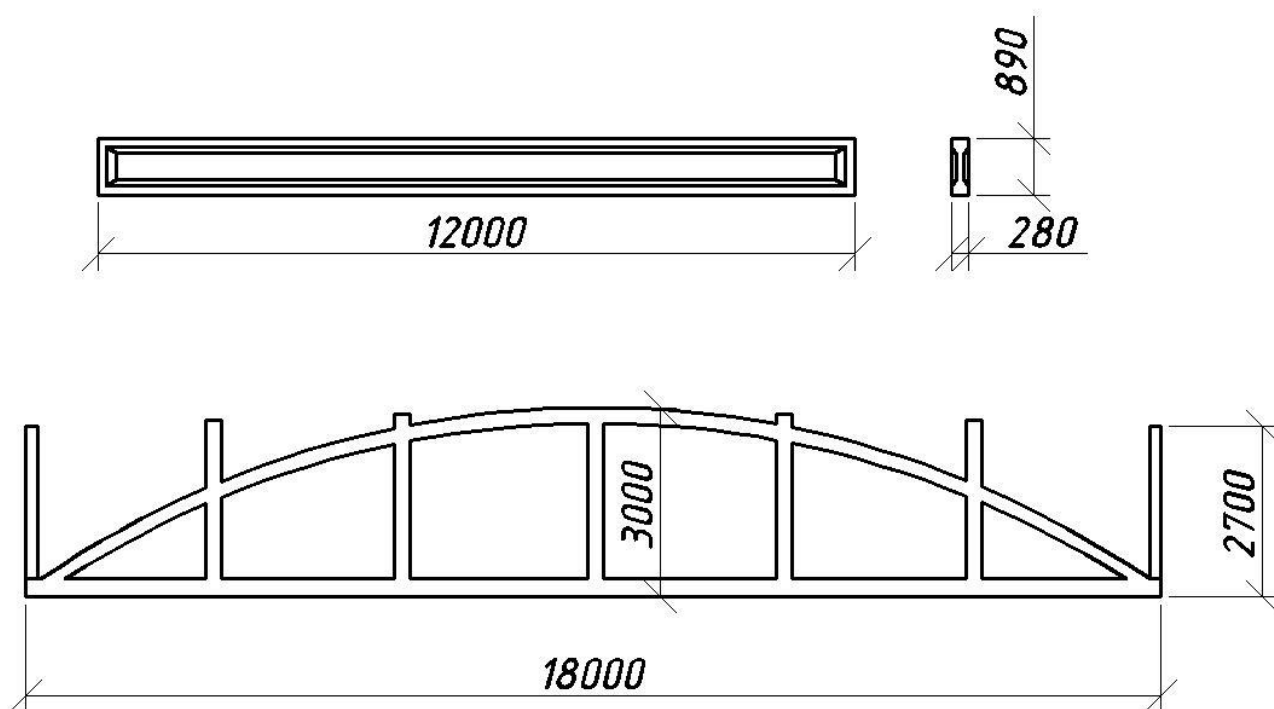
Схема несучих залізобетонних конструкцій покрівлі
